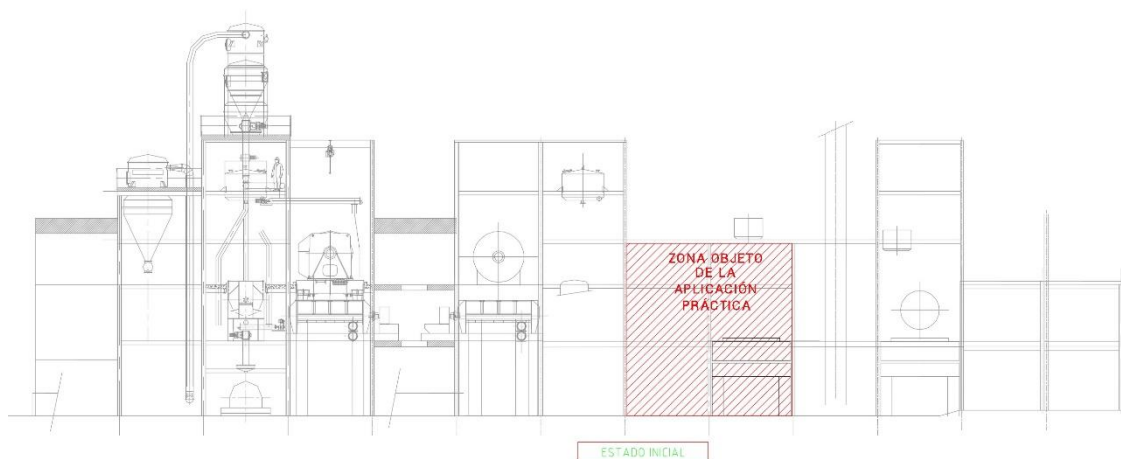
Plano AutoCAD del alzado de la nave industrial. En rojo se remarca la zona objeto de la aplicación práctica.
